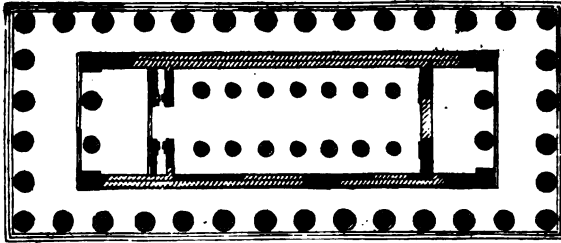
Grundriss des Poseidontempels zu Pästum.
